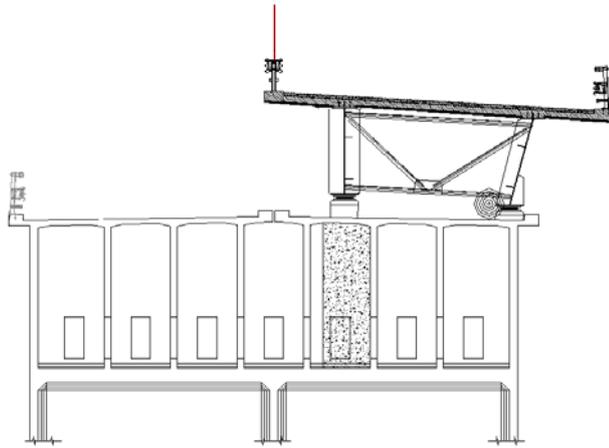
Viadotto Jannello - sezione che evidenzia la predisposizione del nuovo impalcato direttamente al di sopra del sedime storico
